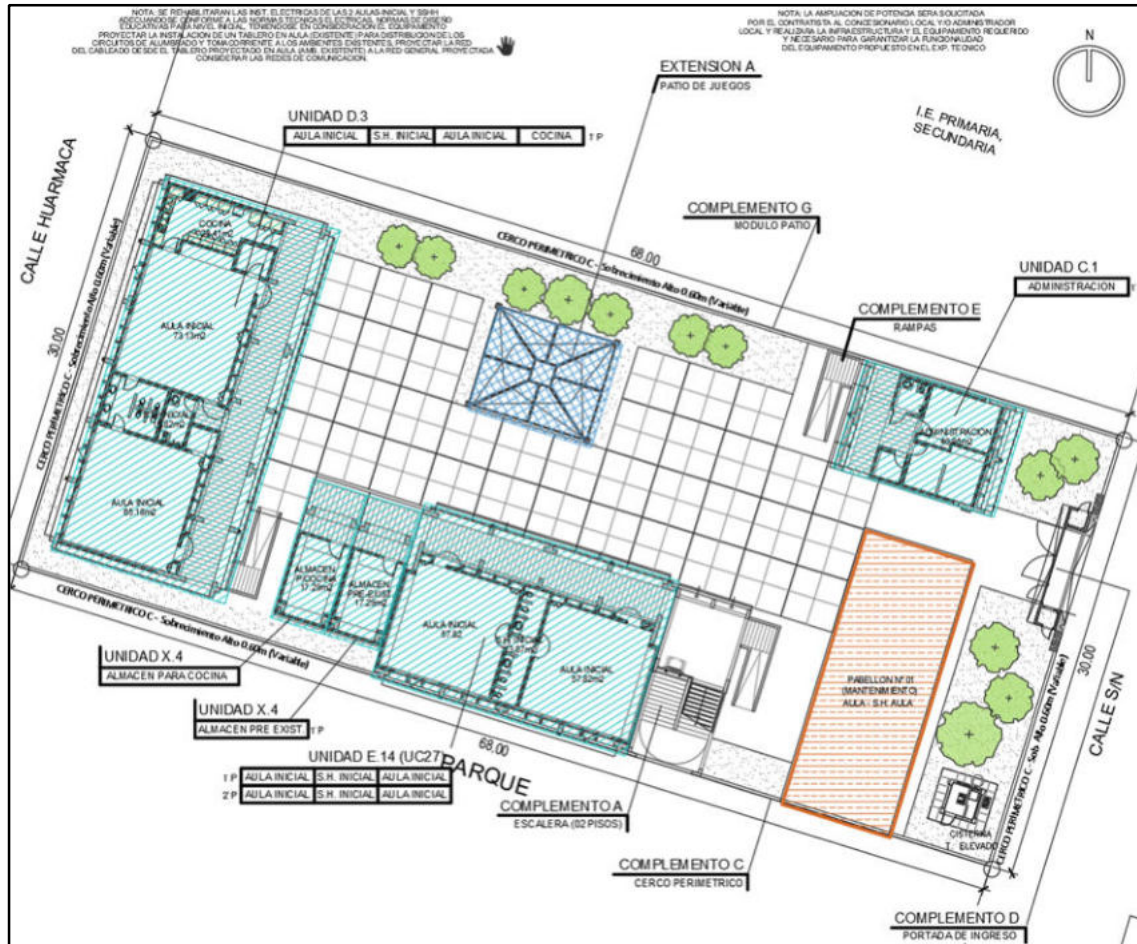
IE 032 – CL 410078 – Plano de Cabida. Fuente: Elaboración propia.
